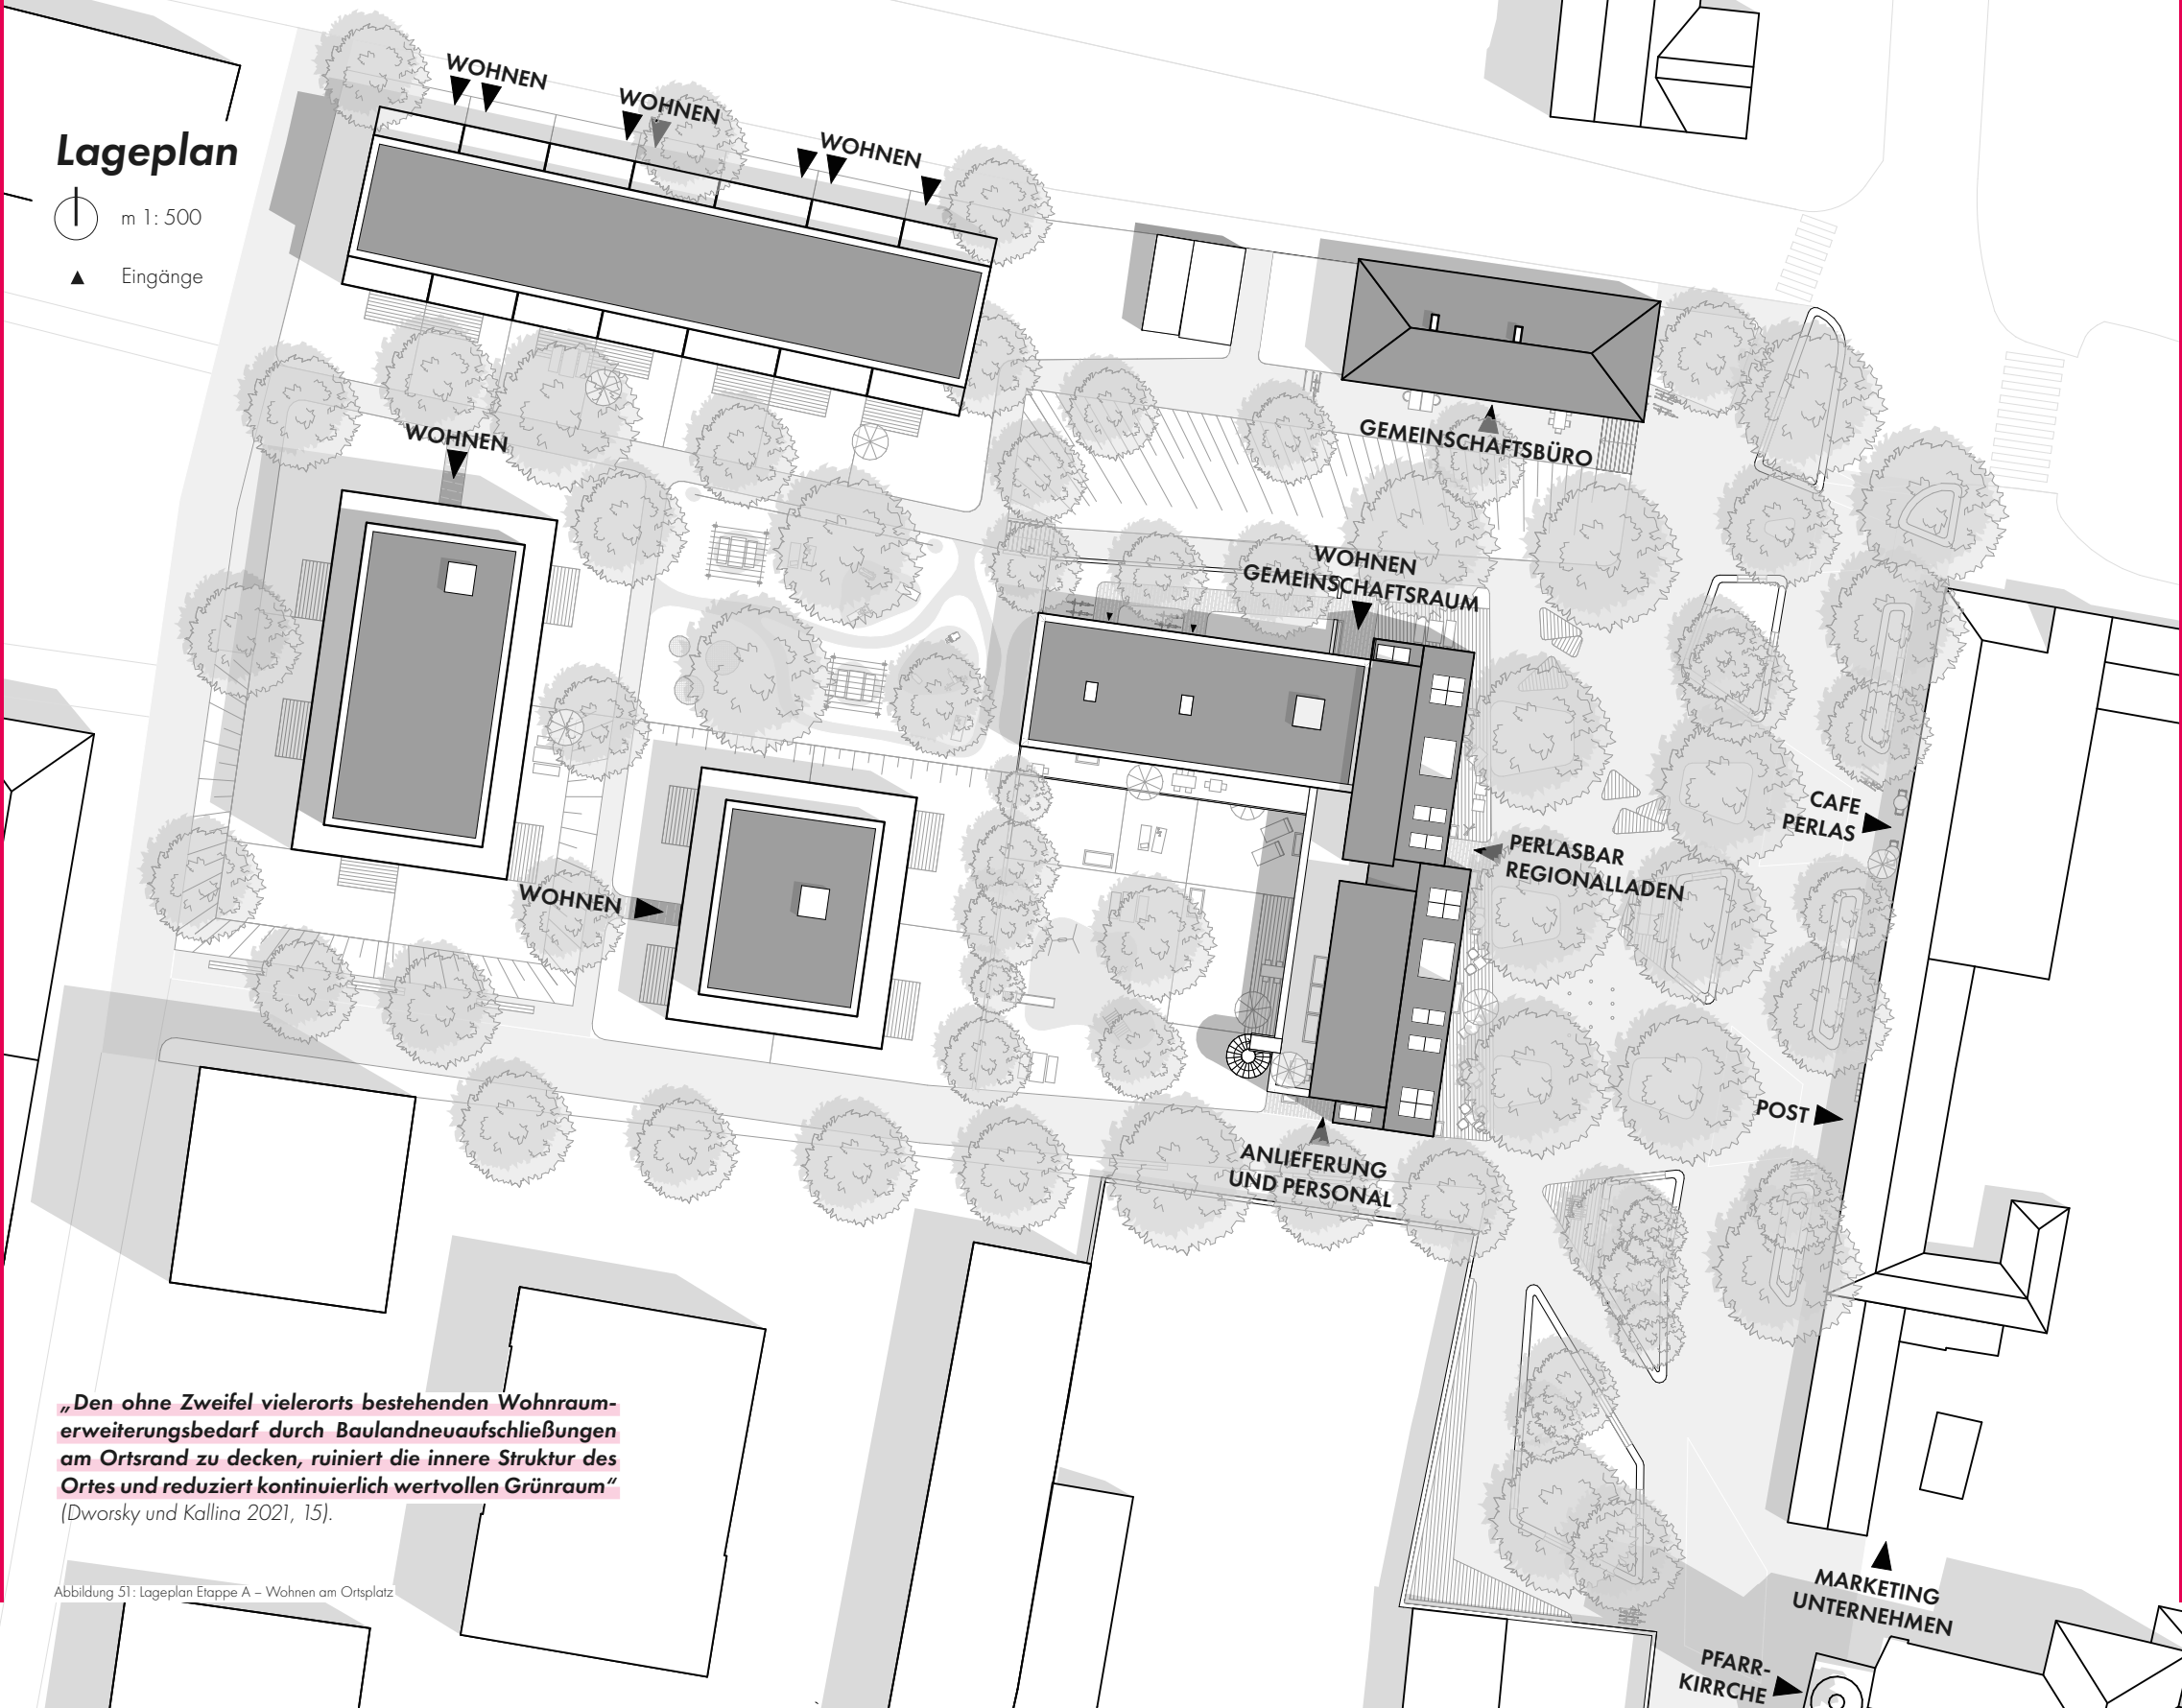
Lageplan Etappe A - Wohnen am Ortsplatz
